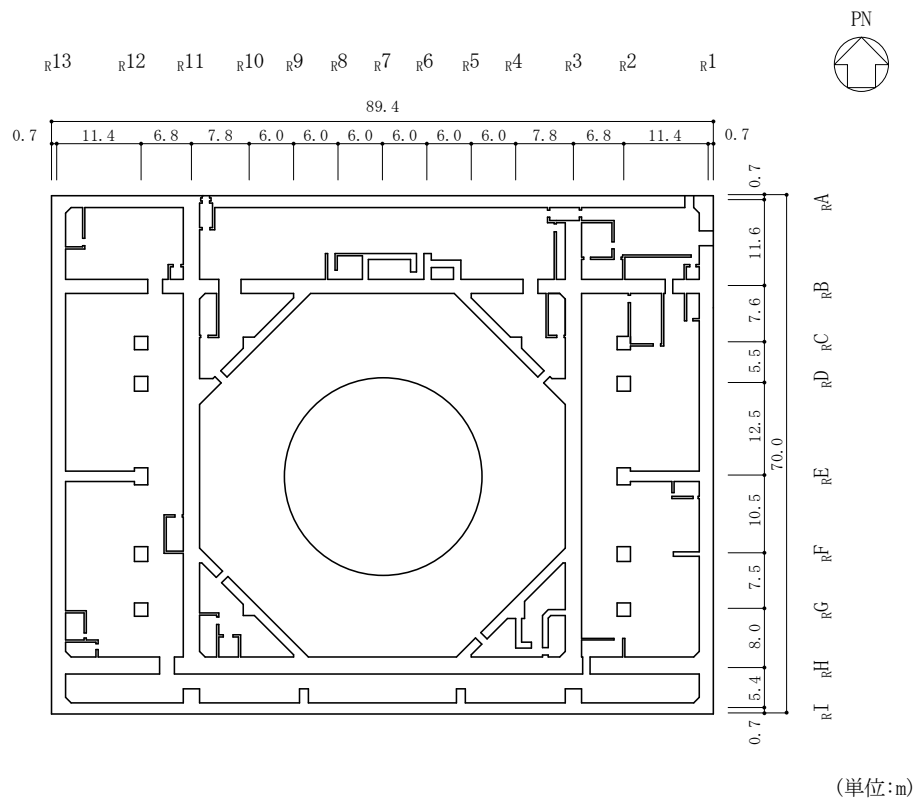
(2) 原子炉建物の概略平面図 (EL 8.8m)
